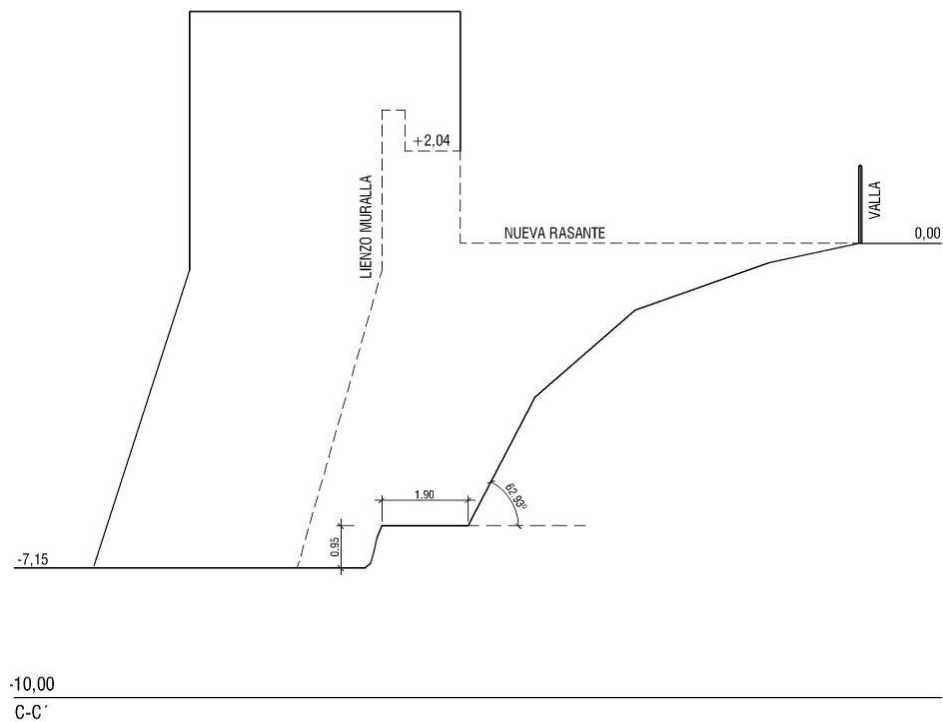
Sección transversal del talud entre las torres Norte y Noroeste. Estado modificado. (Lima, M., 2010)
